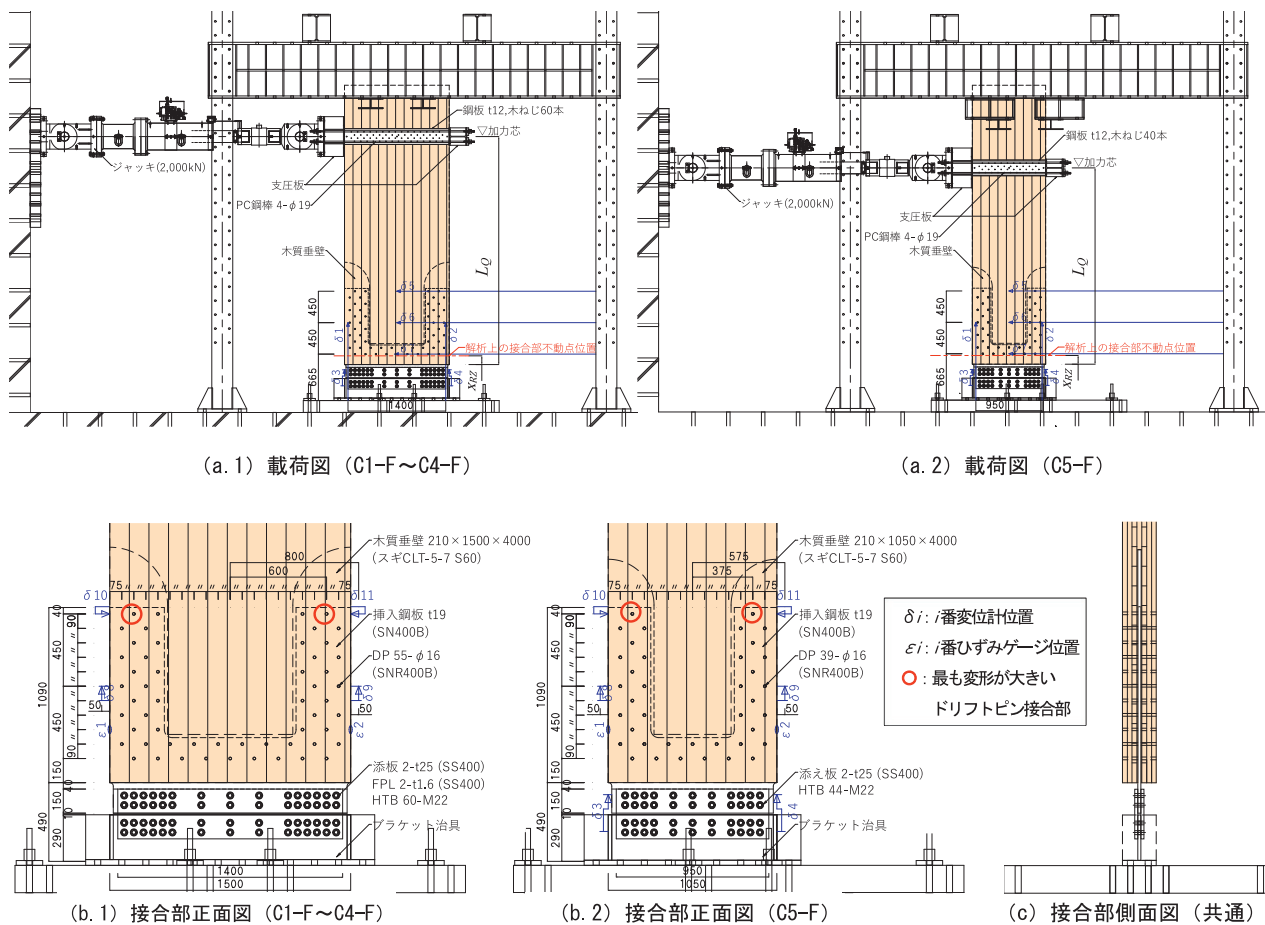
接合部端部実大面内曲げ試験概要図 (単位: mm)
